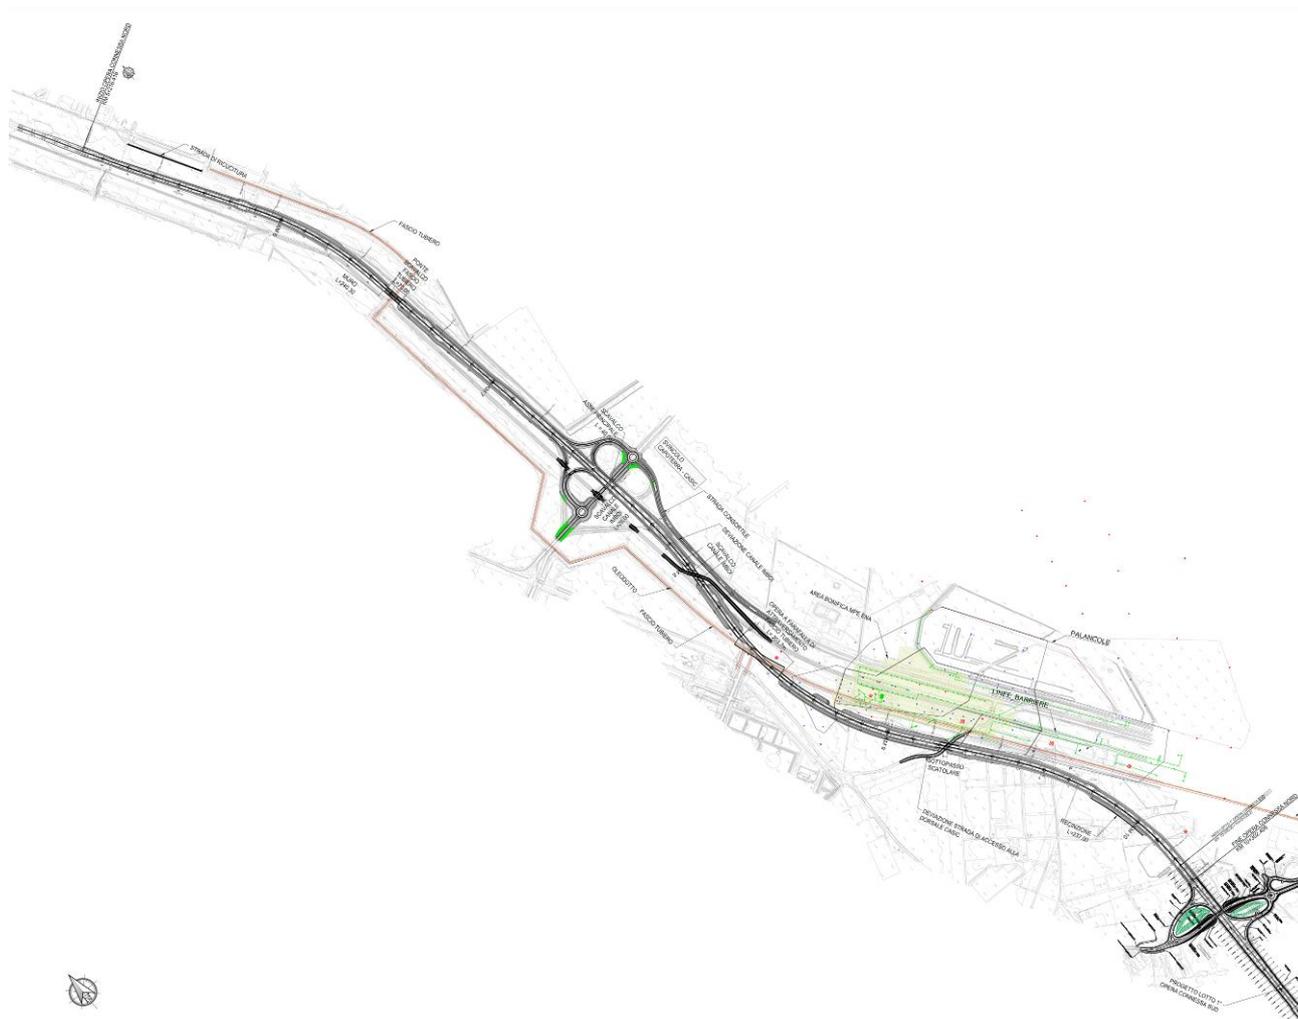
Stralcio Planimetria d'insieme Opera Connessa Nord
